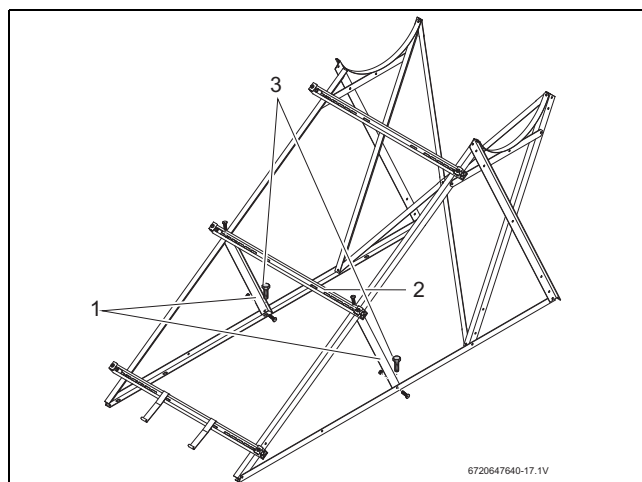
Apoyos adicionales para sistema de cubierta plana (sistema de 150/200 I)
